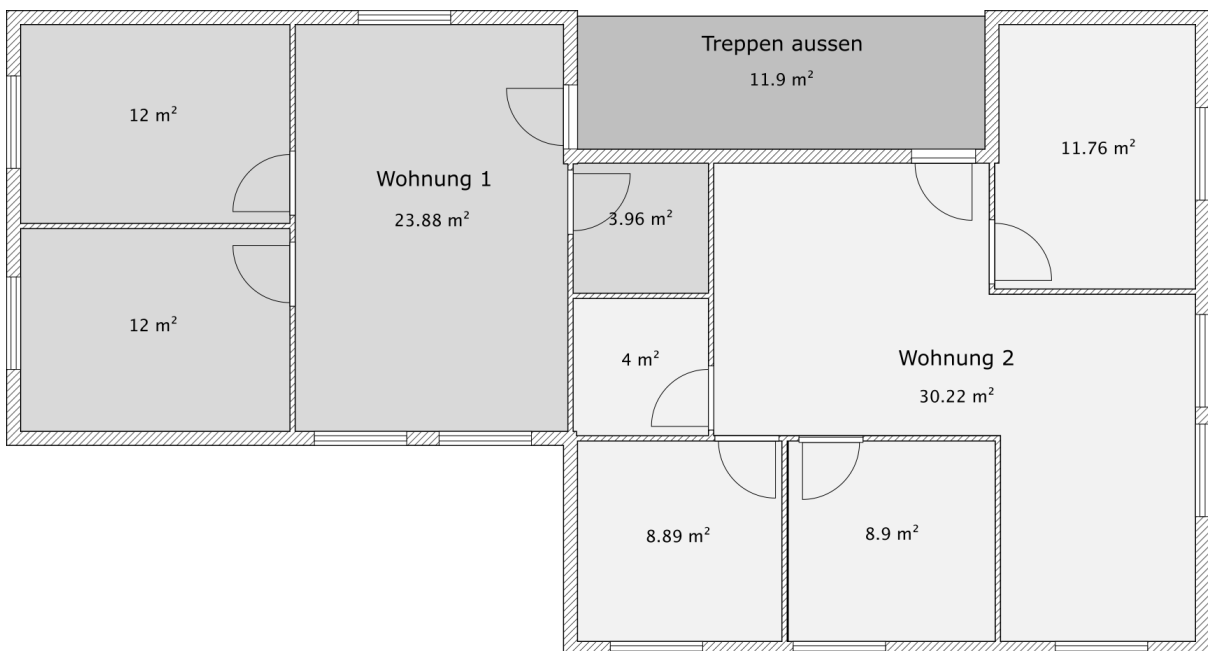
Regelgeschoss mit Treppenhaus ausserhalb Gebäudehülle
